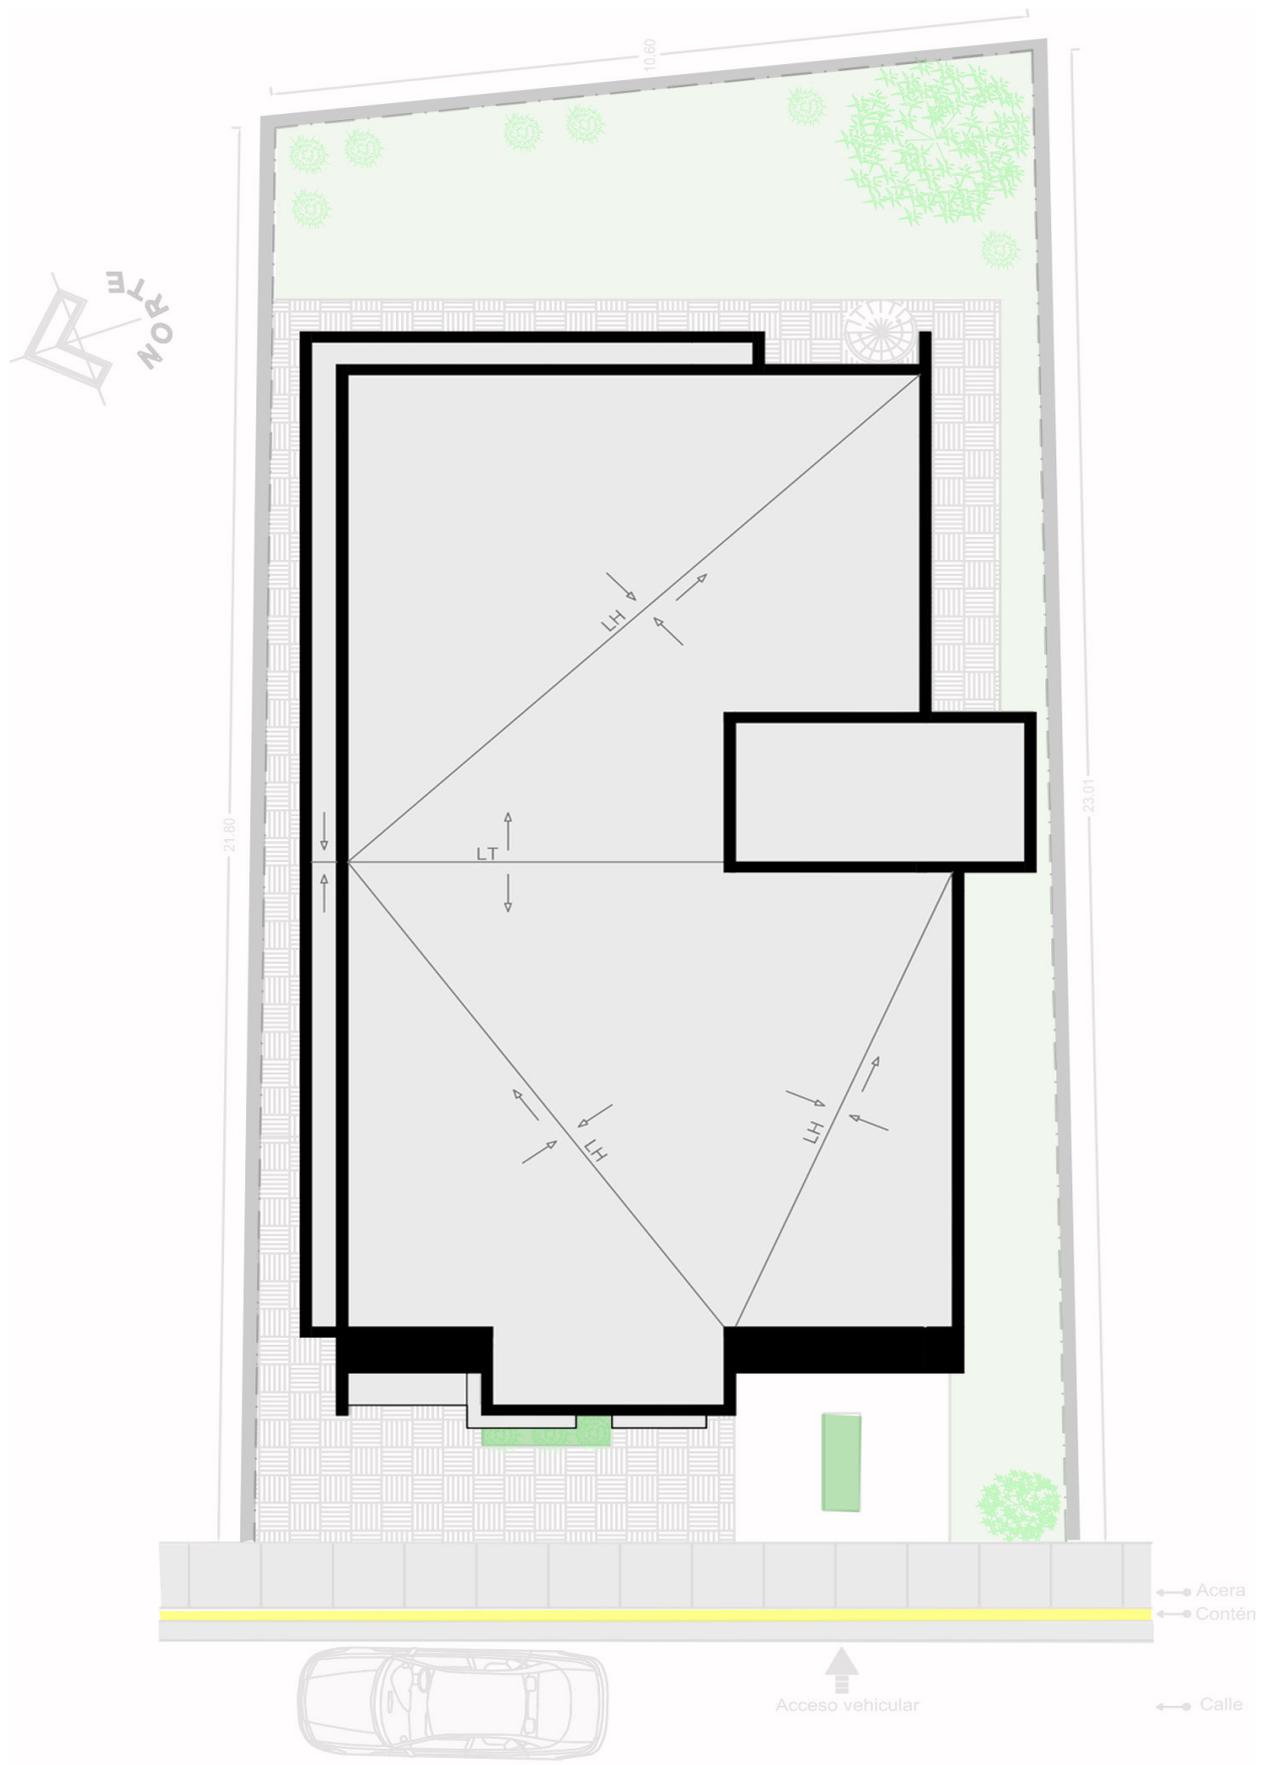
PLANTA ARQ. DE CONJUNTO TECHO
